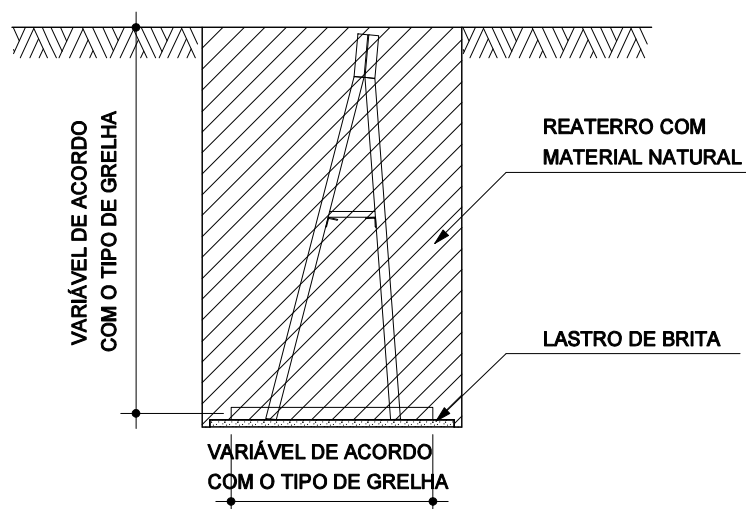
FUNDAÇÃO TIPO GRELHA
